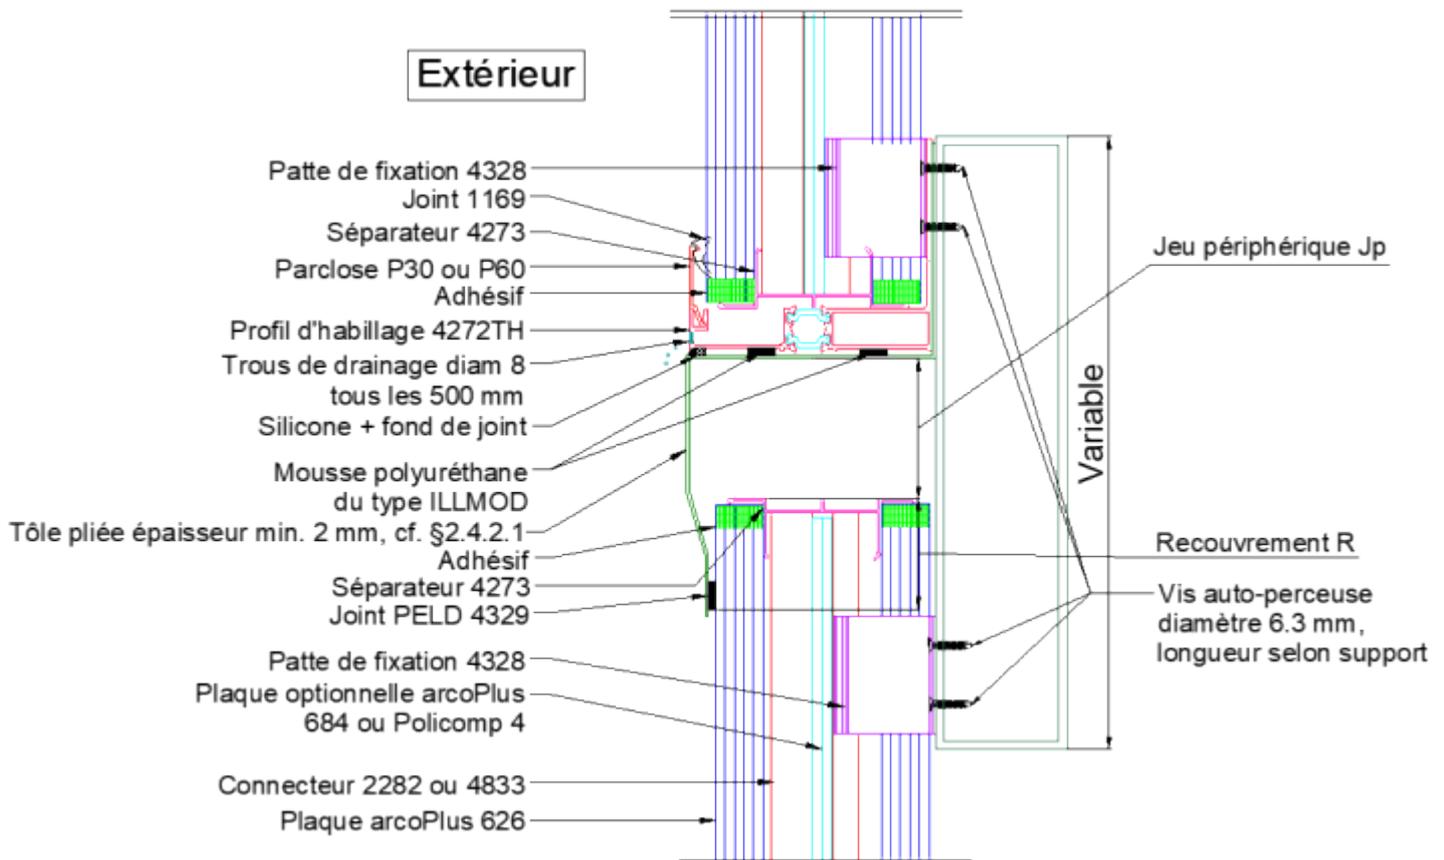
Raccord de hauteur n°3 - façade basse limitée à 16 mètres de haut
